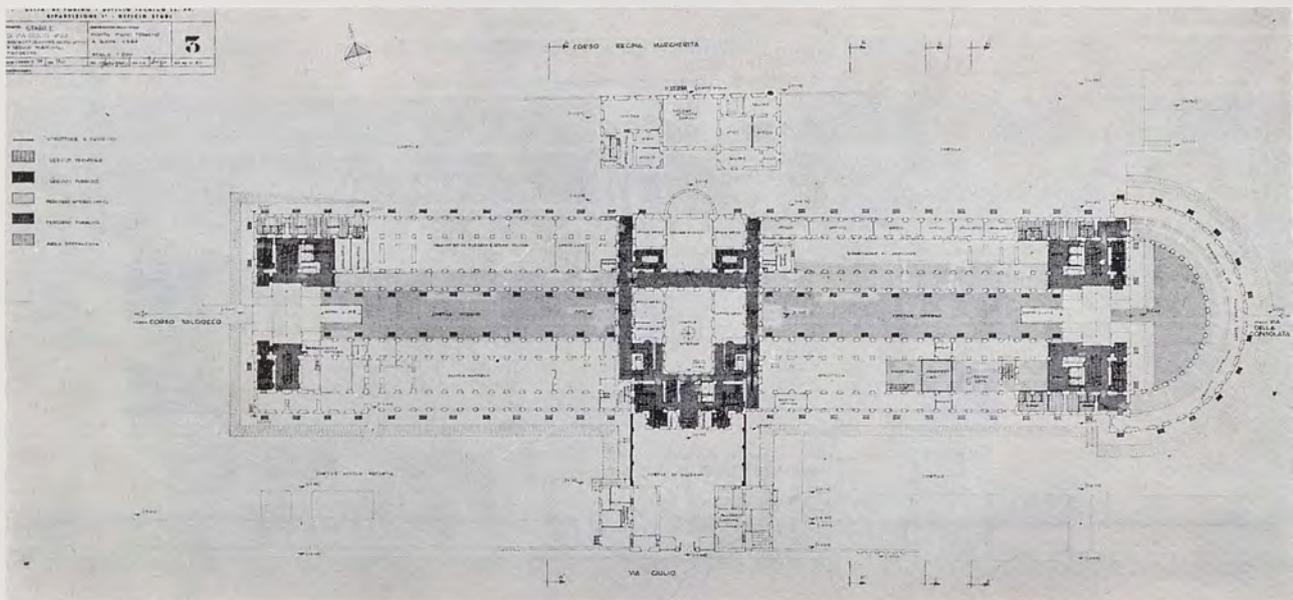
b - Il progetto di ristrutturazione: pianta del piano terreno.
